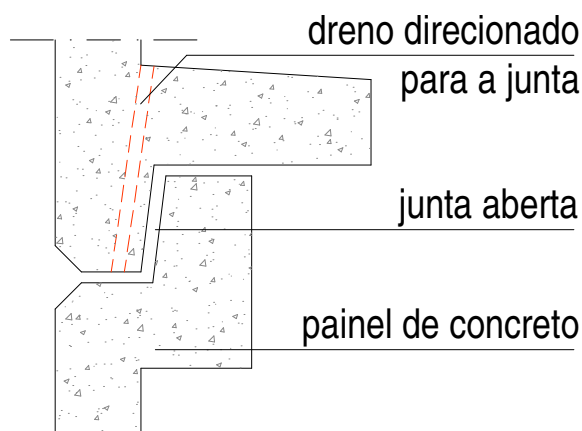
Detalhe da drenagem da junta aberta
